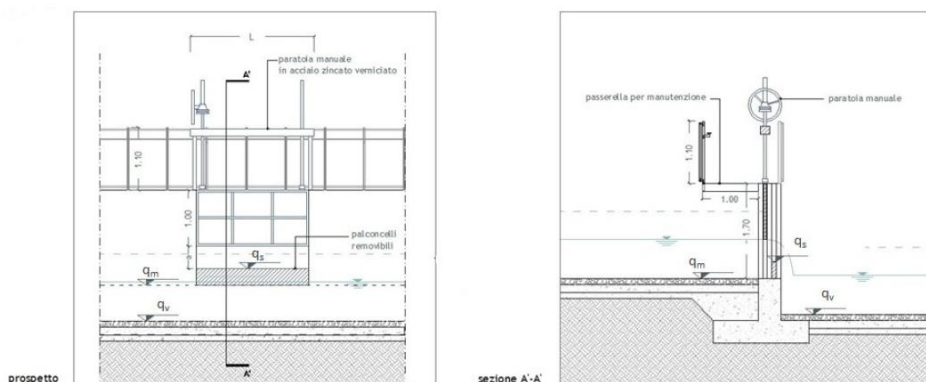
Prospetto e sezione briglia di regolazione Canale perimetrale
